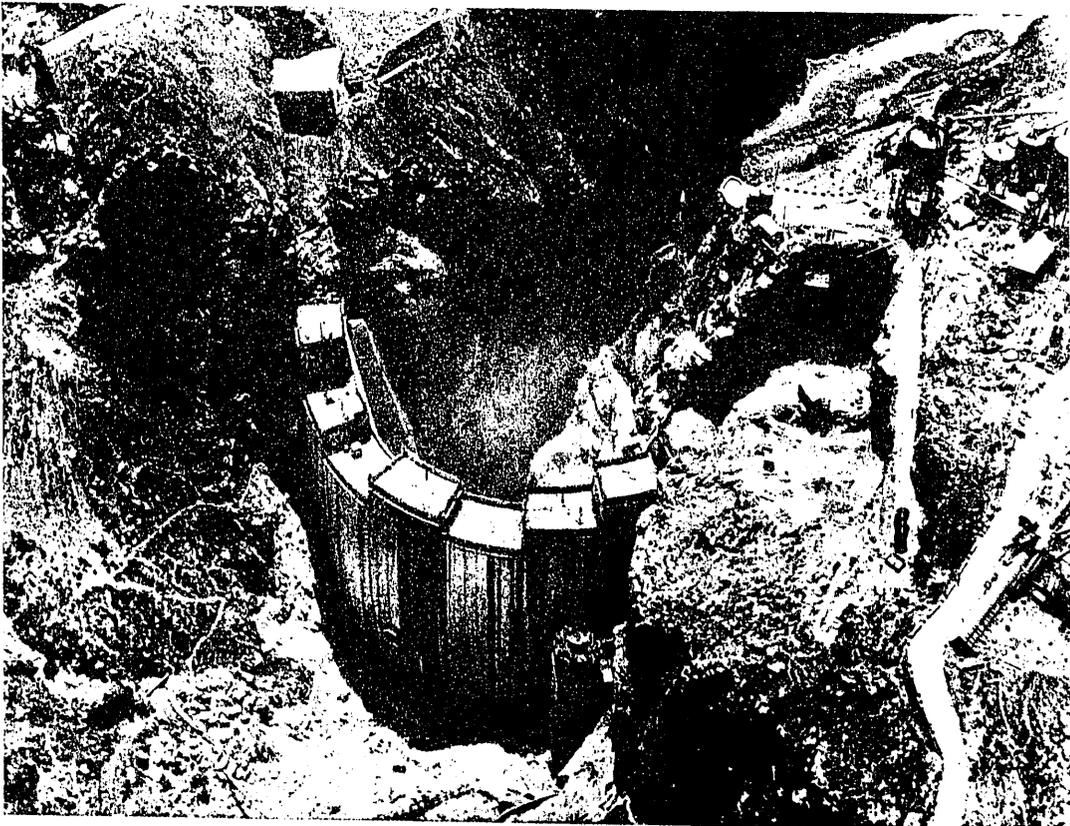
Hormigonado de la presa y arranque de la torre de toma. Puede observarse también el túnel para el aliviadero.
